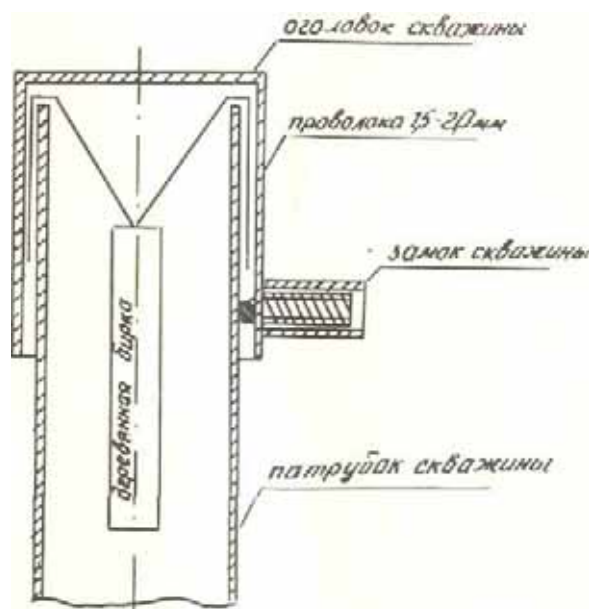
Конструкция покрышек (оголовков) наблюдательныхскважин
